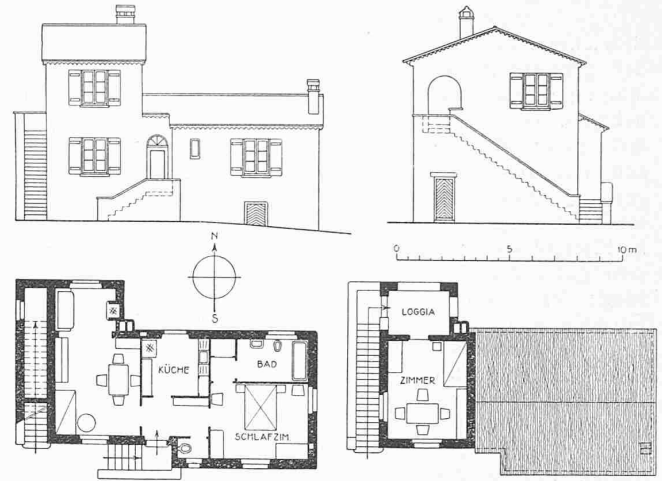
Haus P. in St. Paul-en-Forêt. — Ansichten und Grundrisse 1 : 300.
